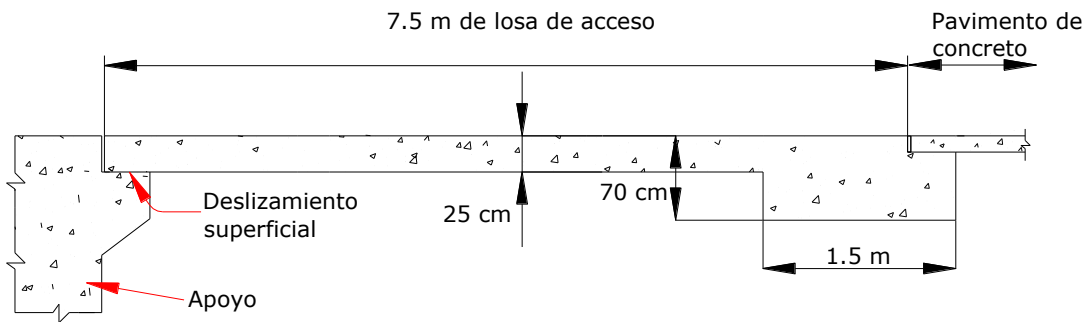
Losa de acceso de 7.5 m y continuación de pavimento
